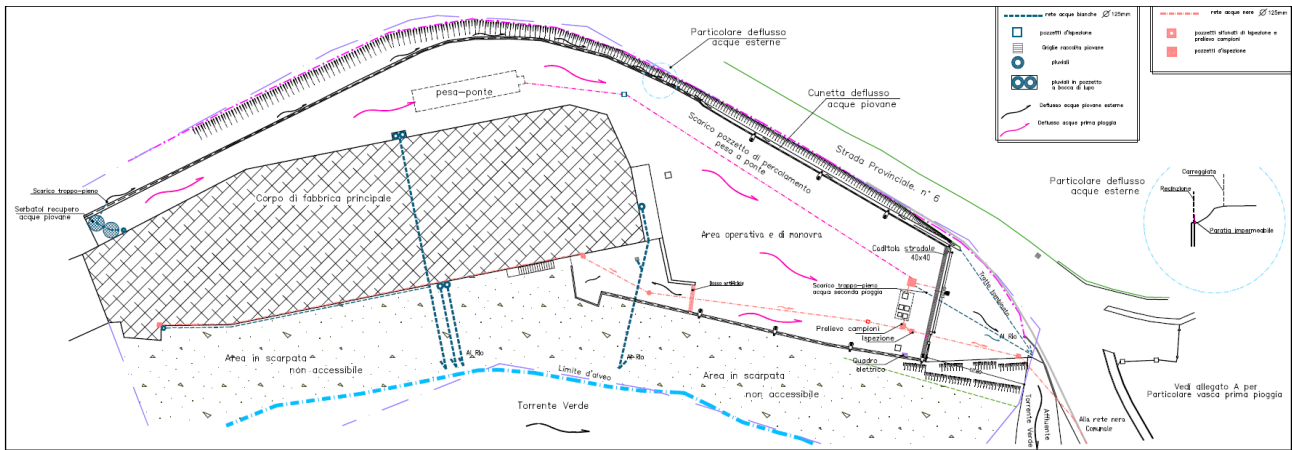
Elaborato planimetrico dello schema delle reti interni di raccolta delle acque meteoriche.
